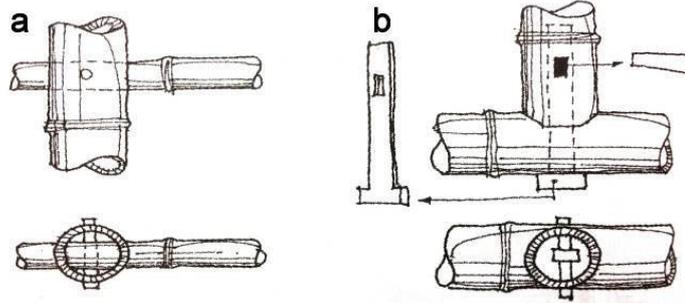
Penerapan sambungan sendi pada sambungan bambu
